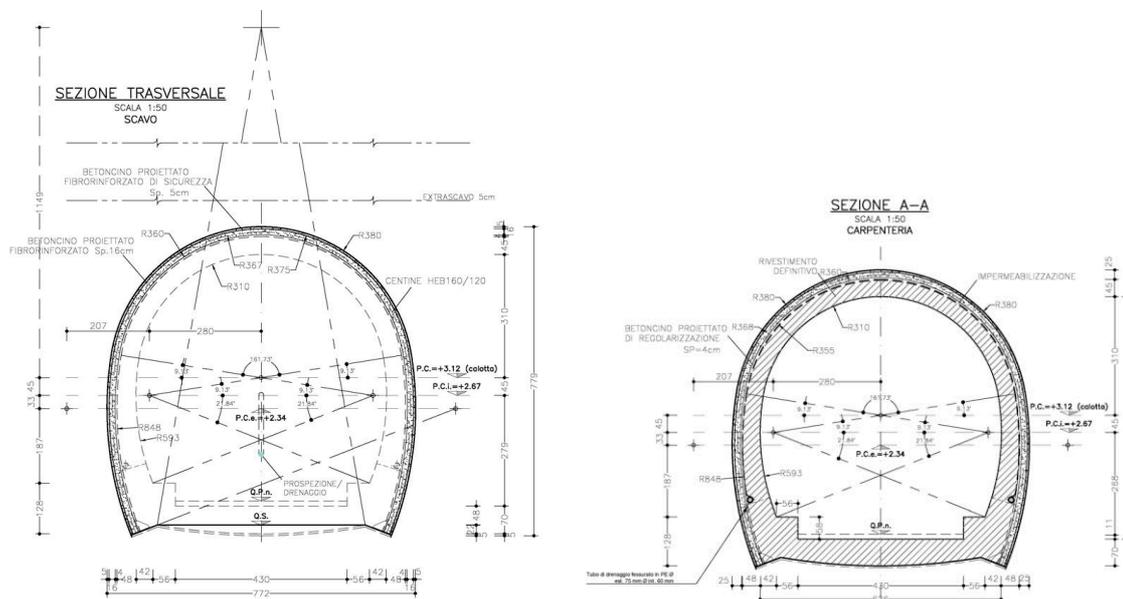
Sezione N-CE-B1 – Sezione di scavo (a sx) e Carpenteria (a dx).
